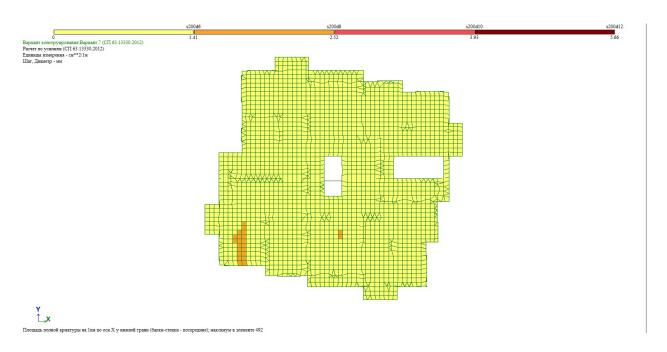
Нижнее армирование перекрытия этажа по оси ${\bf X}$
